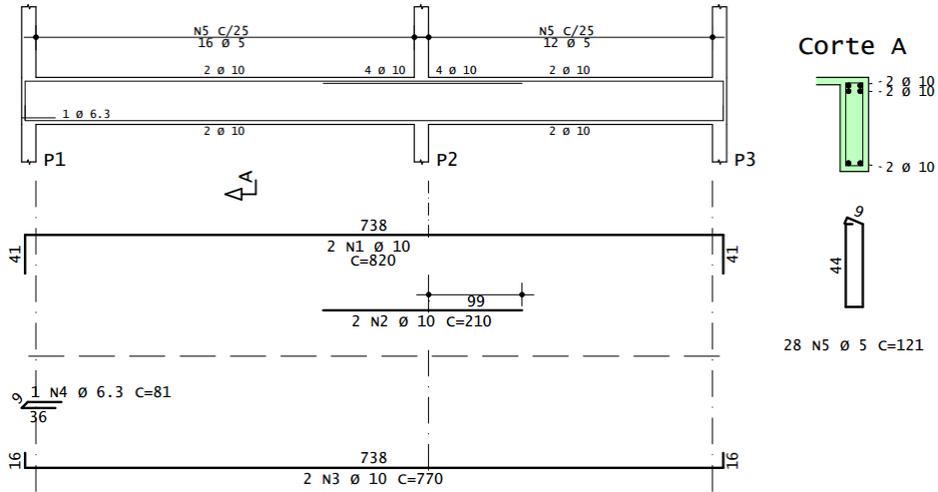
Armadura da viga V2 – pavimento superior (nível +3,00)
